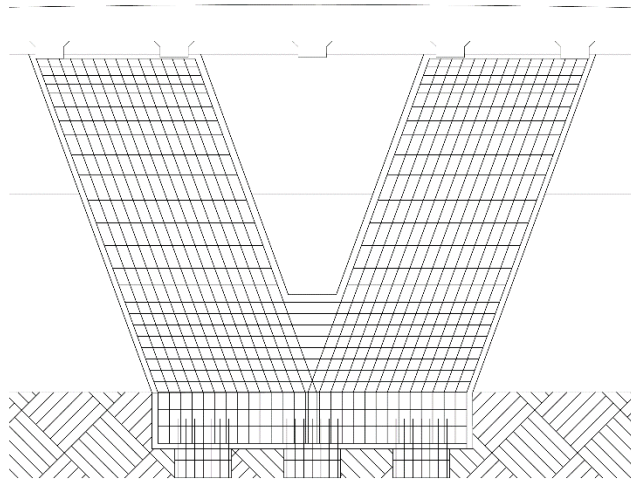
Detalle constructivo pilares. Elaboracion propia, (AutoCad).
